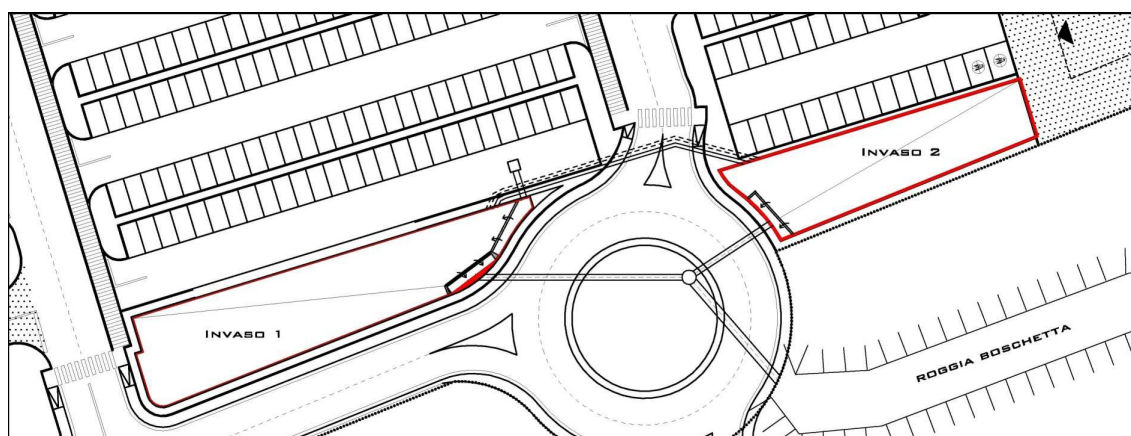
Schema planimetrico degli invasi per la laminazione delle acque in eccesso, rappresentato sulla planimetria di progetto.
